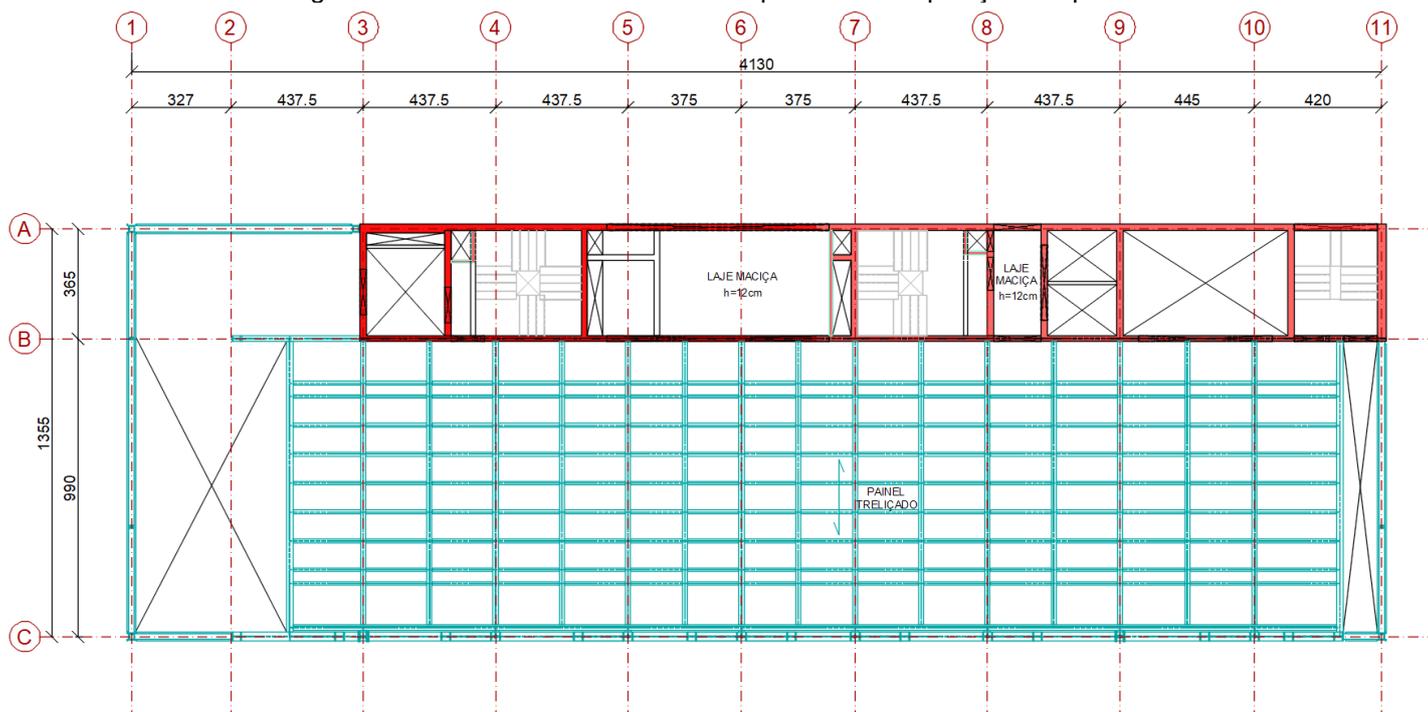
Planta de Arquitetura - Sexto pavimento: exposição temporária
